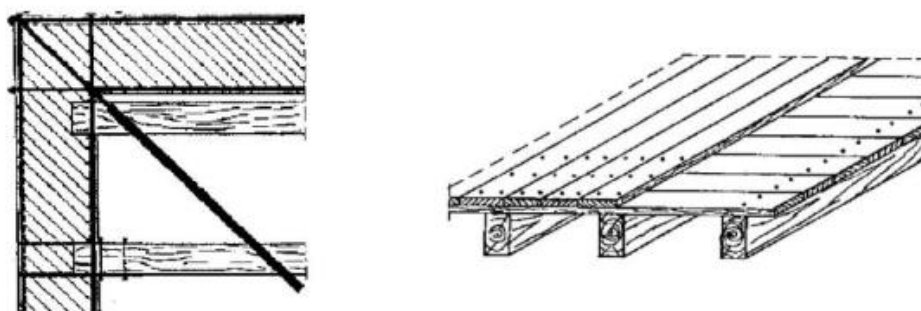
Detajl sidranja sovprežnega estriha (levo), primer priprave armature pred vlivanjem estriha (desno) [17]
